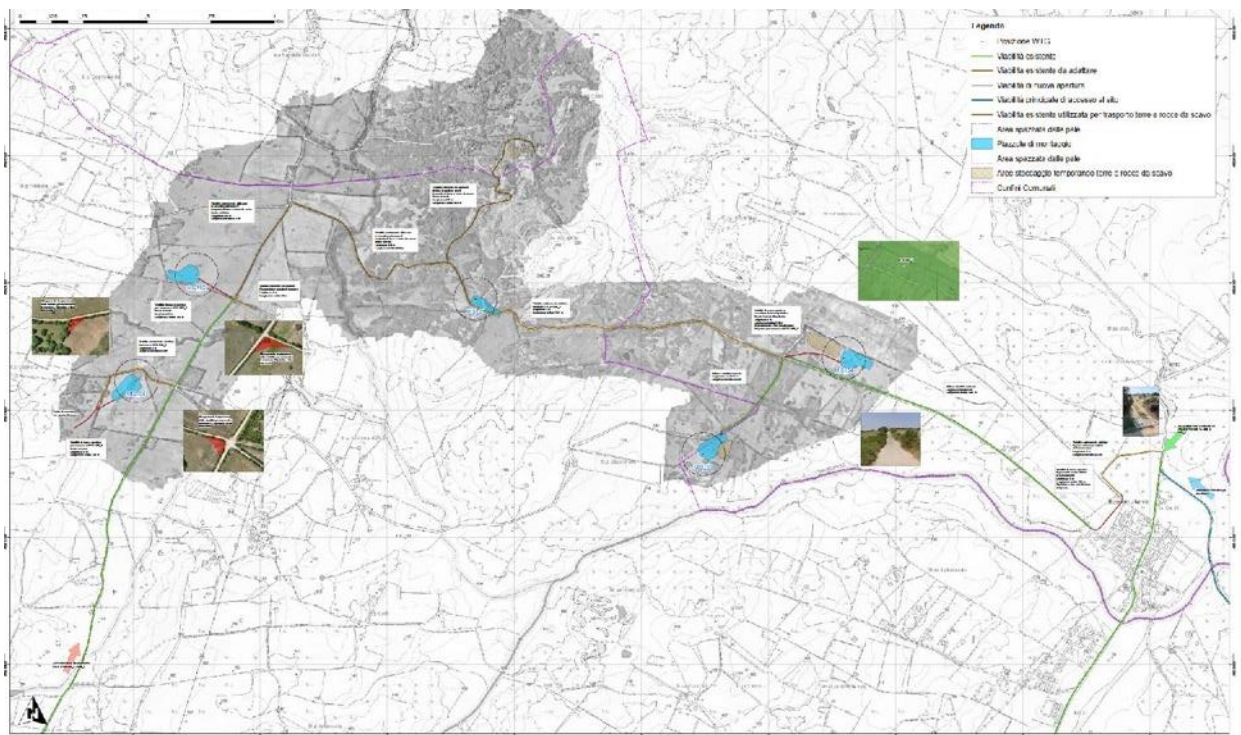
Estratto elaborato 01.W.D34 – Viabilità di cantiere
